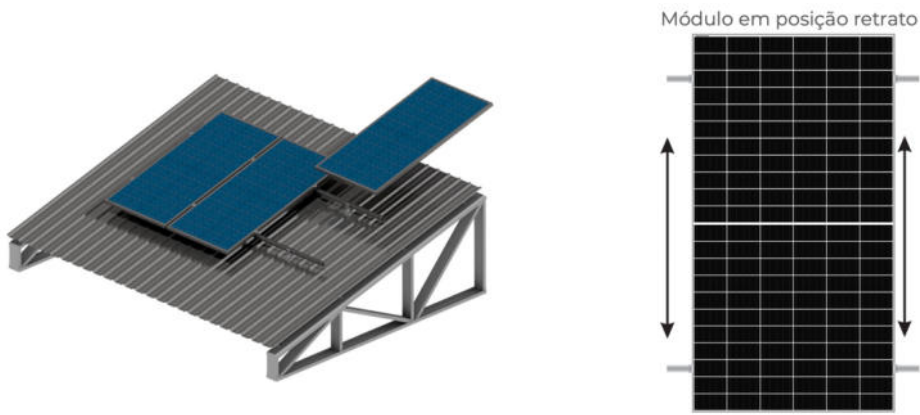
Detalhes da estrutura PHB de montagem em telha trapezoidal
